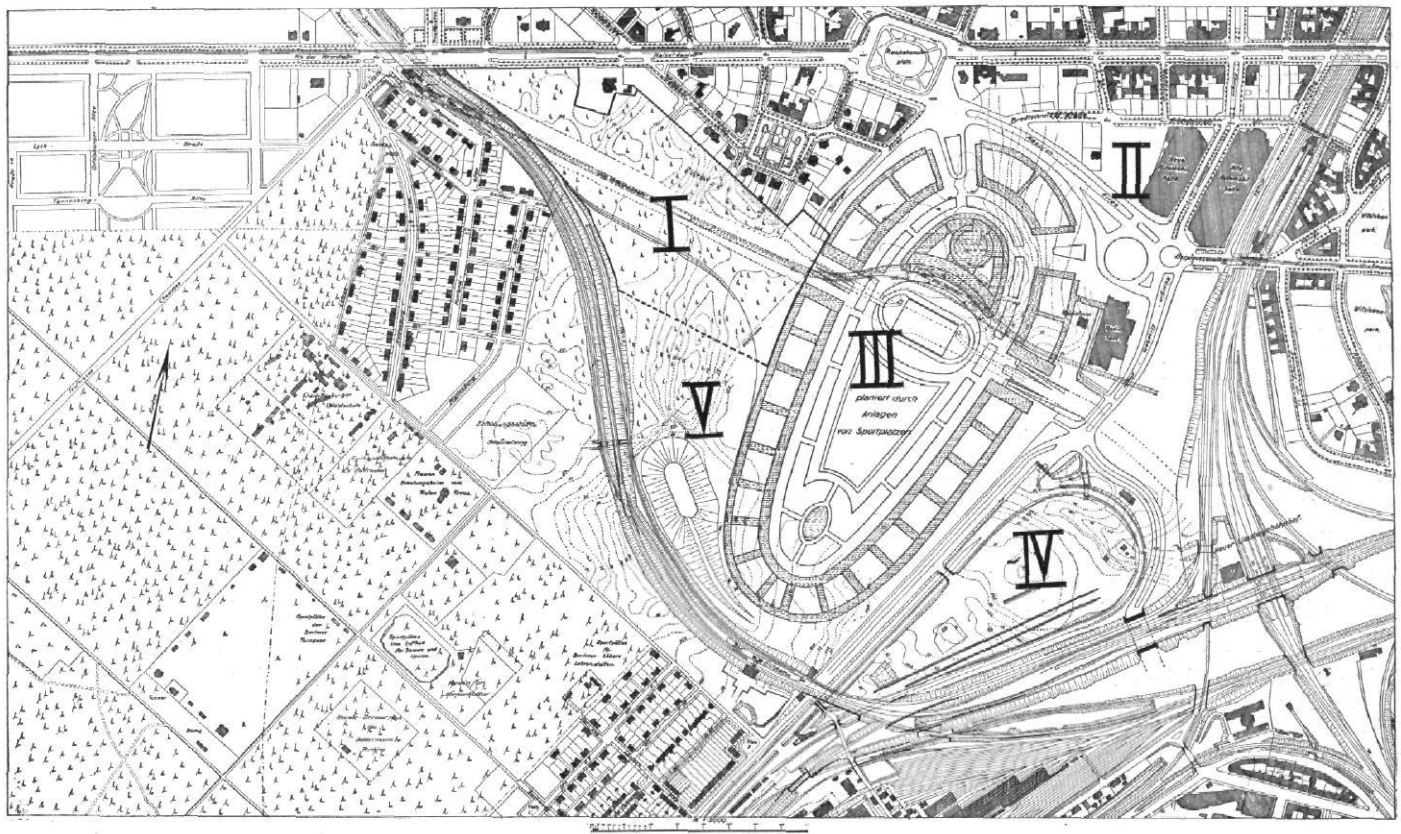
Abb. I / Lageplan des Messe- und Ausstellungs-Geländes in Berlin
